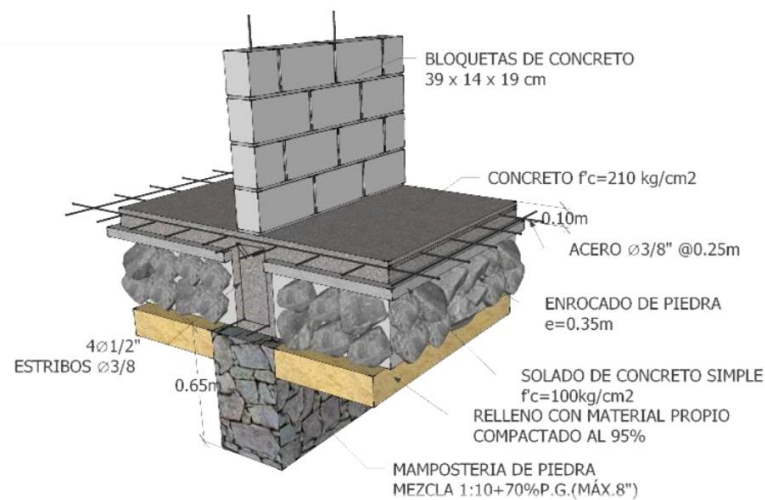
Detalle de cimentación de muros de albañilería armada
